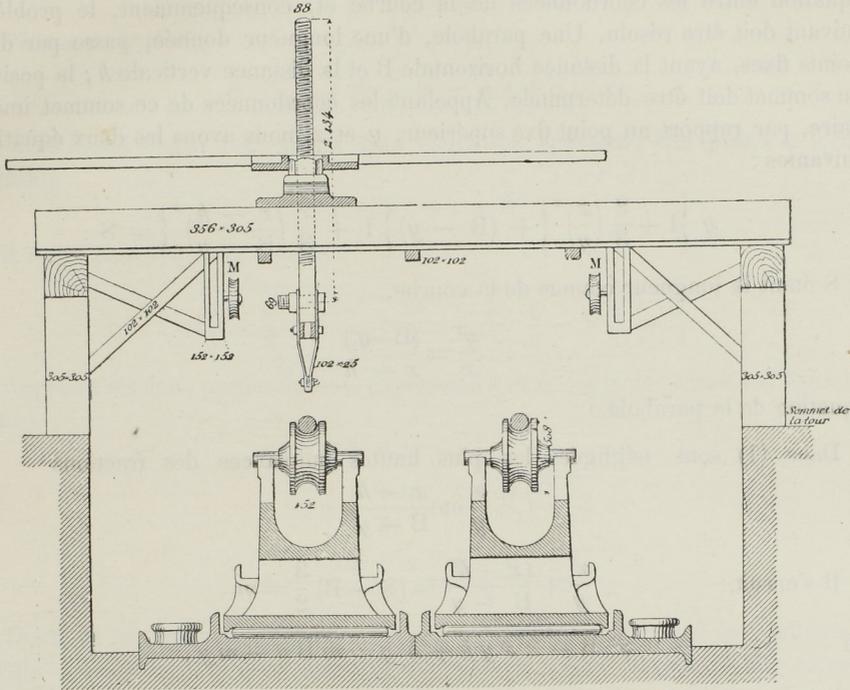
Coupe transversale. — Pose des faisceaux sur les selles.
